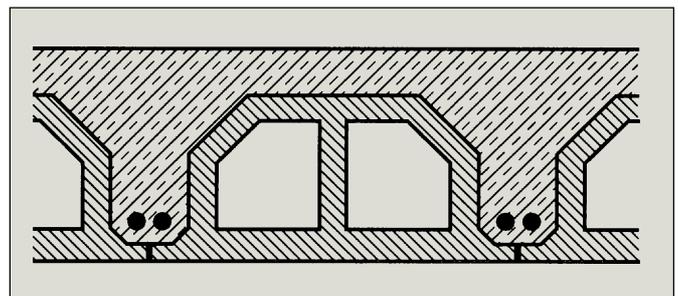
Stahlbeton-Rippendecke mit statisch nicht mitwirkenden Zwischenbauteilen aus Beton
